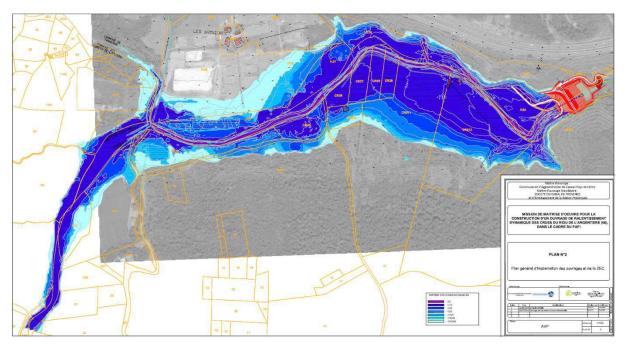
Plan d'implantation général des ouvrages et de la ZEC
